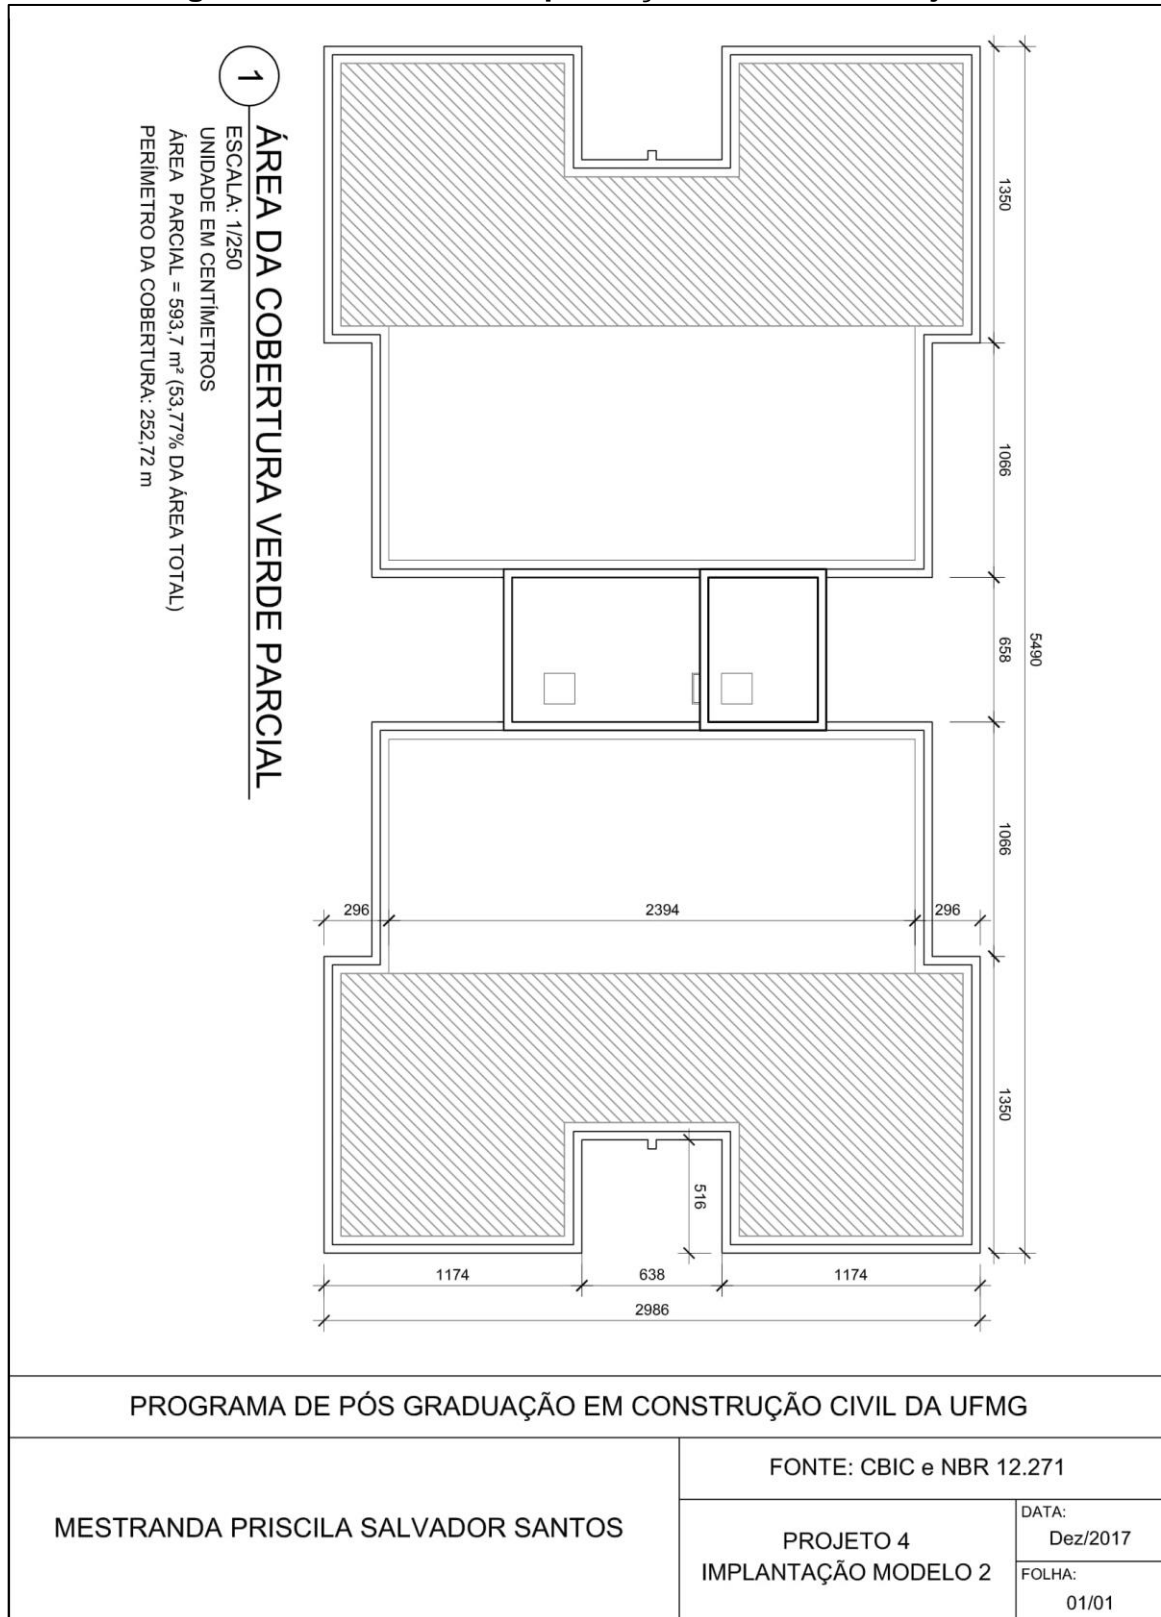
Planta de Implantação Modelo 2 – Projeto 3
